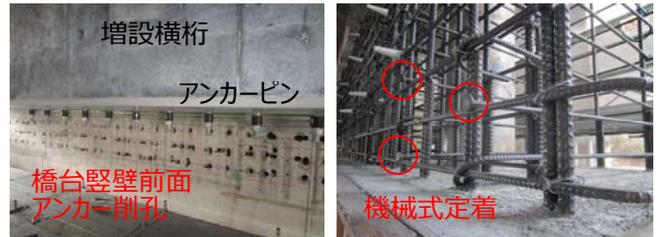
アンカー削孔状況 図-4 RC巻立て配筋状況
